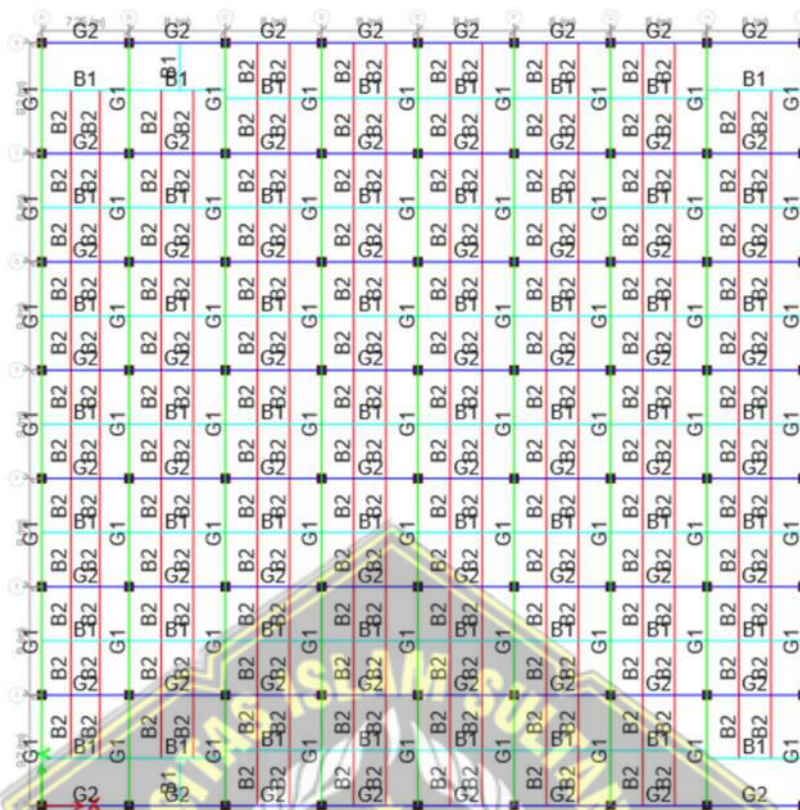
Denah Kolom Lantai 1-3 Gedung B
